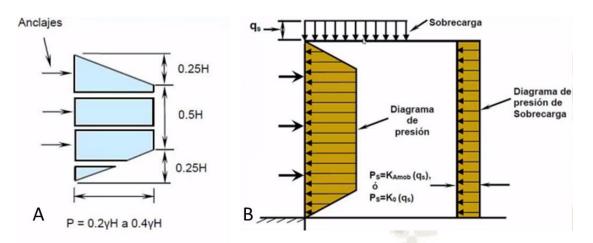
(A) Diagrama aparente de presión de tierra en muros anclados en suelos con arcillas duras fisuradas, (B) Diagrama de presión de tierra en muros anclados
